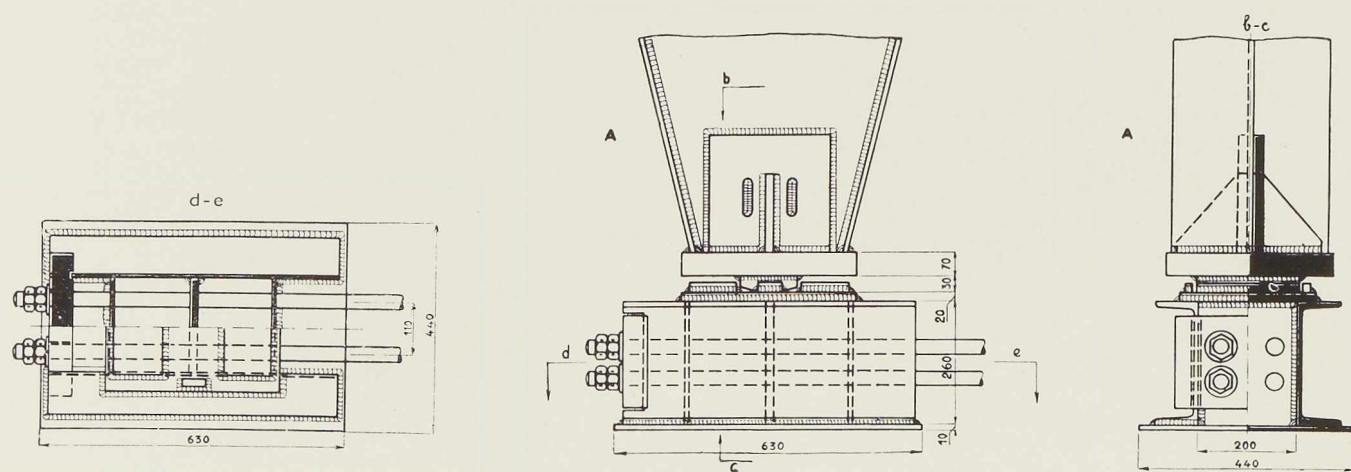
Plan d'une rotule de base, assemblée par soudure. On remarque les tirants joignant les deux rotules de base (voir figure 10).
